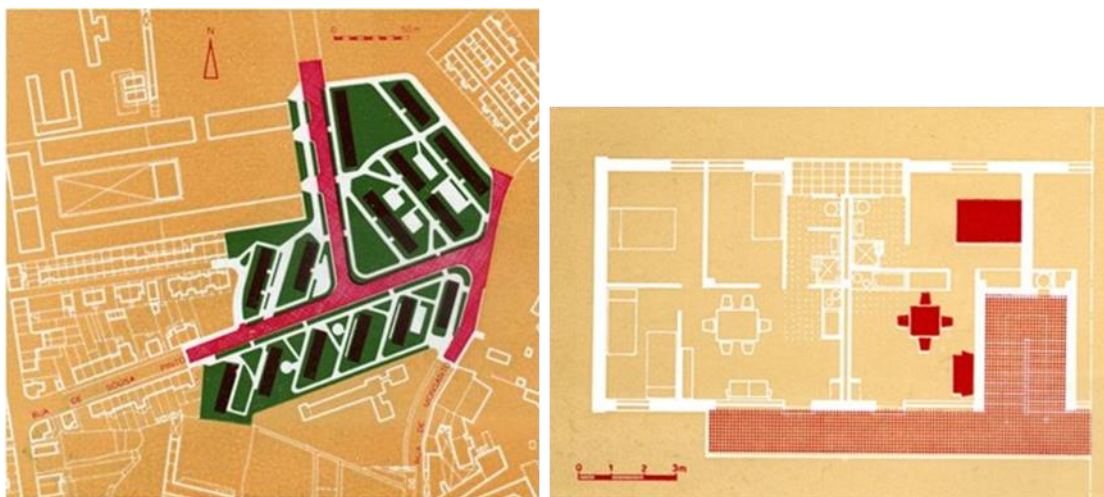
Bairro do Carvalho (“solução A” do “Plano de Melhoramentos”) - implantação e planta de habitação. Fonte: CMP, 1966.
